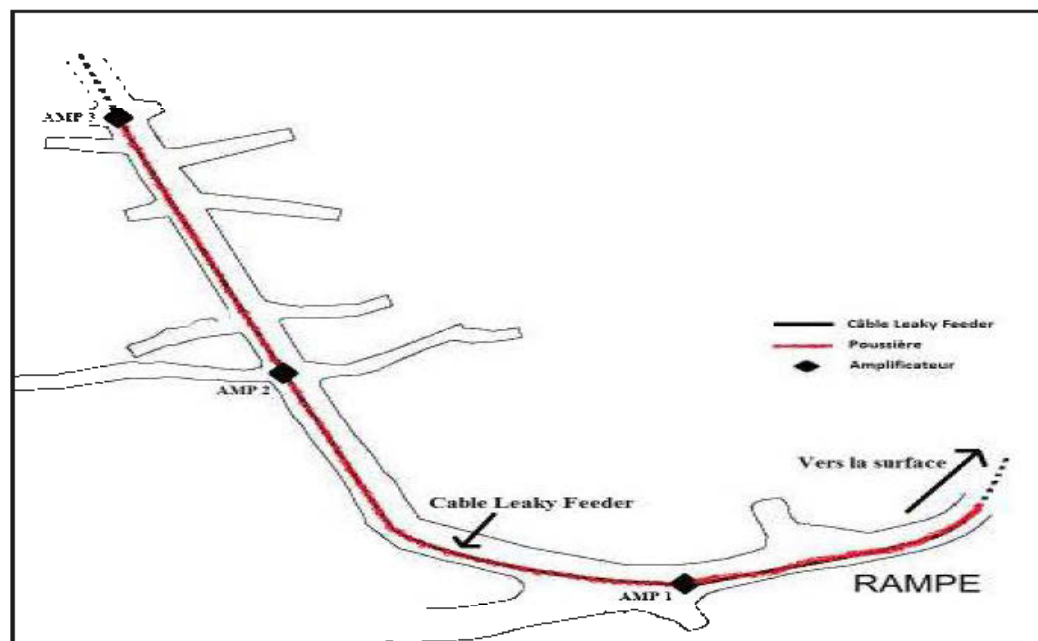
Un plan minier qui montre le câble installé avec poussière
